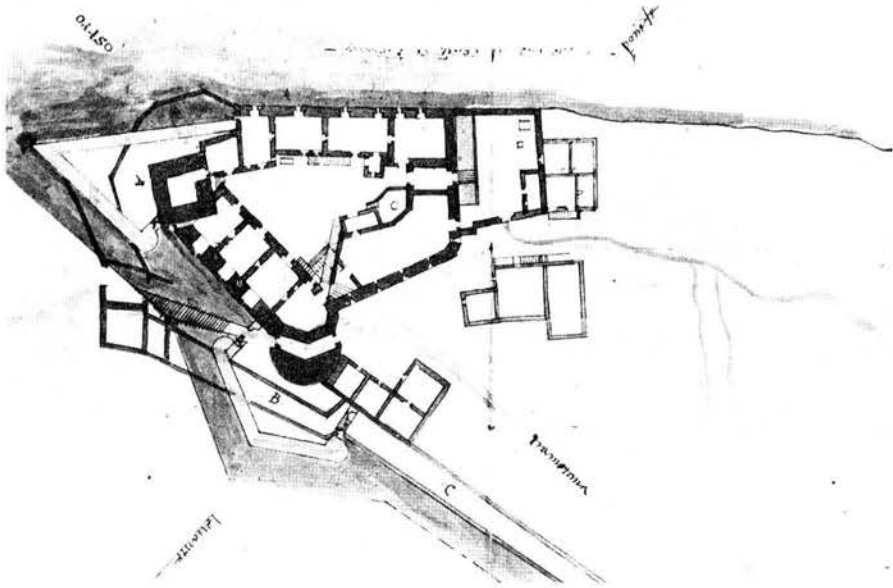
Pianta del pianoterra del castello di Pisino rilevata nella prima metà del secolo XVI. A sinistra, circondata dall'antemurale poligonale, è la torre maestra quadrata; a destra si trova l'entrata del castello con il fossato e il ponte levatoio. I due bastioni segnati "A" e "B" nel disegno fanno parte di un progetto seicentesco mai eseguito.
